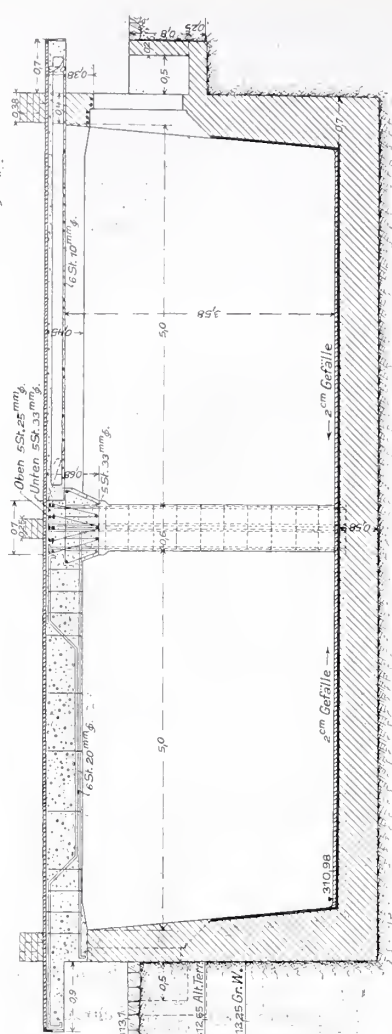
Querschnitt nach c—d des Grundrisses.
